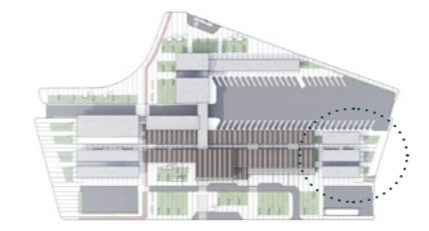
Paquetería, Fachada principal, zona E. Fuente propia
